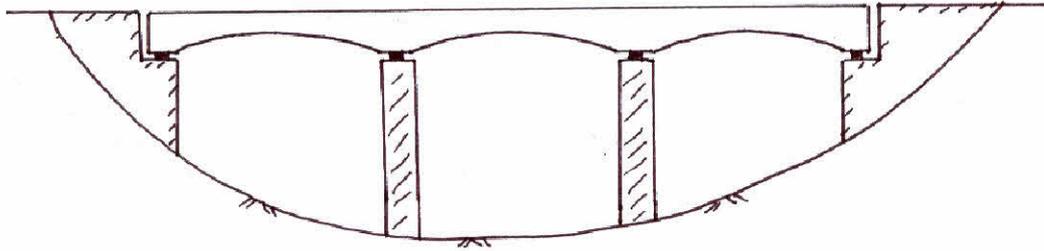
Pont à poutres continues en B.P et de hauteur variable.
